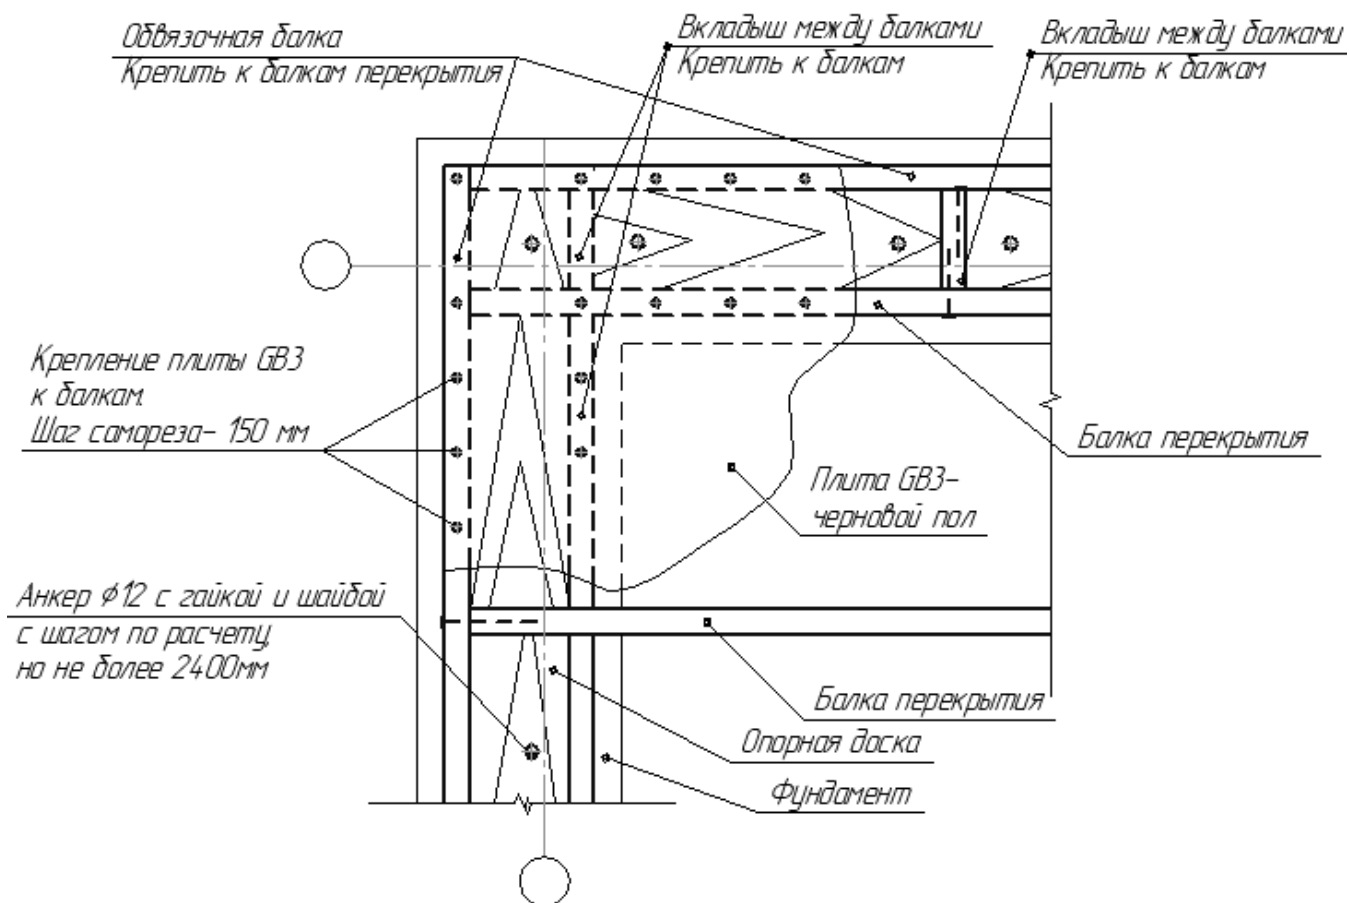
Опирание балок перекрытия на опорную доску, уложенную на фундамент в местах пересечения стен
